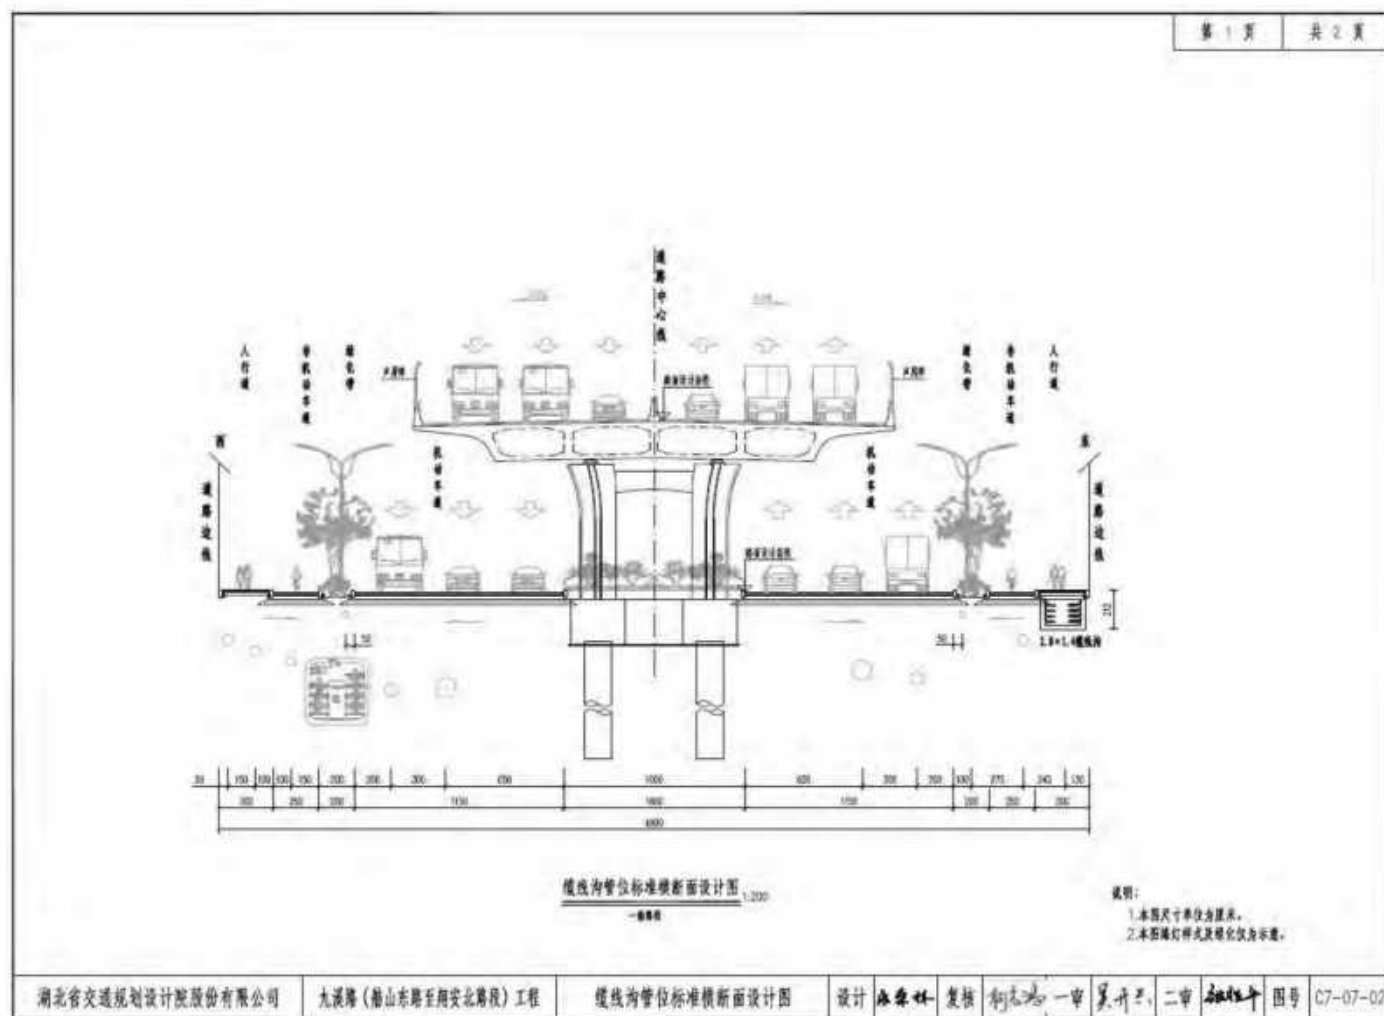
缆线沟管位标准横断面图（一般路段）
